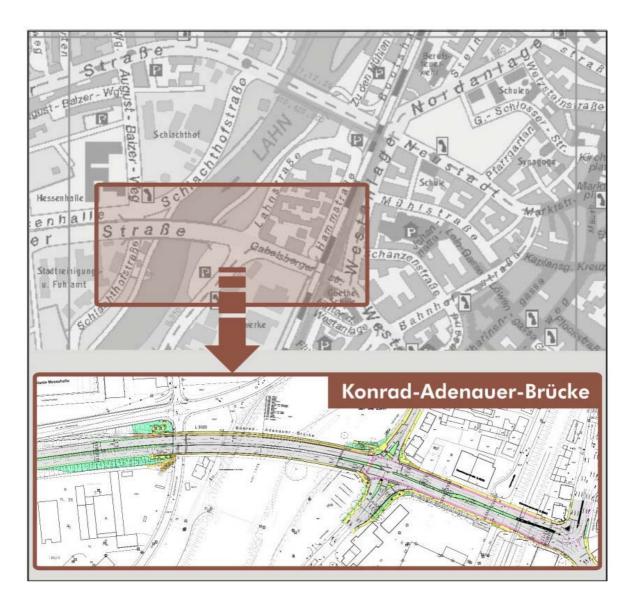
Relevanter Netzausschnitt mit Streckenzug Heuchelheimer Straße - Gabelsberger Straße und Vorabzug Ausbauplanung K.-Adenauer-Brücke Stand 04/ 2009 (Quelle: Spiekermann AG, 2009)
